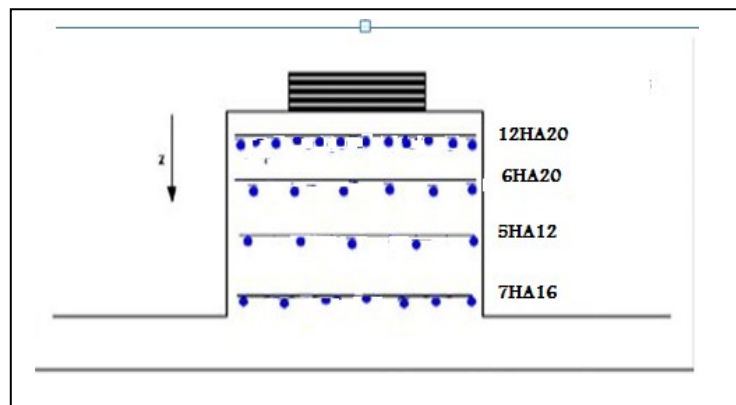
Le ferrailage d'un dés d'appui.
